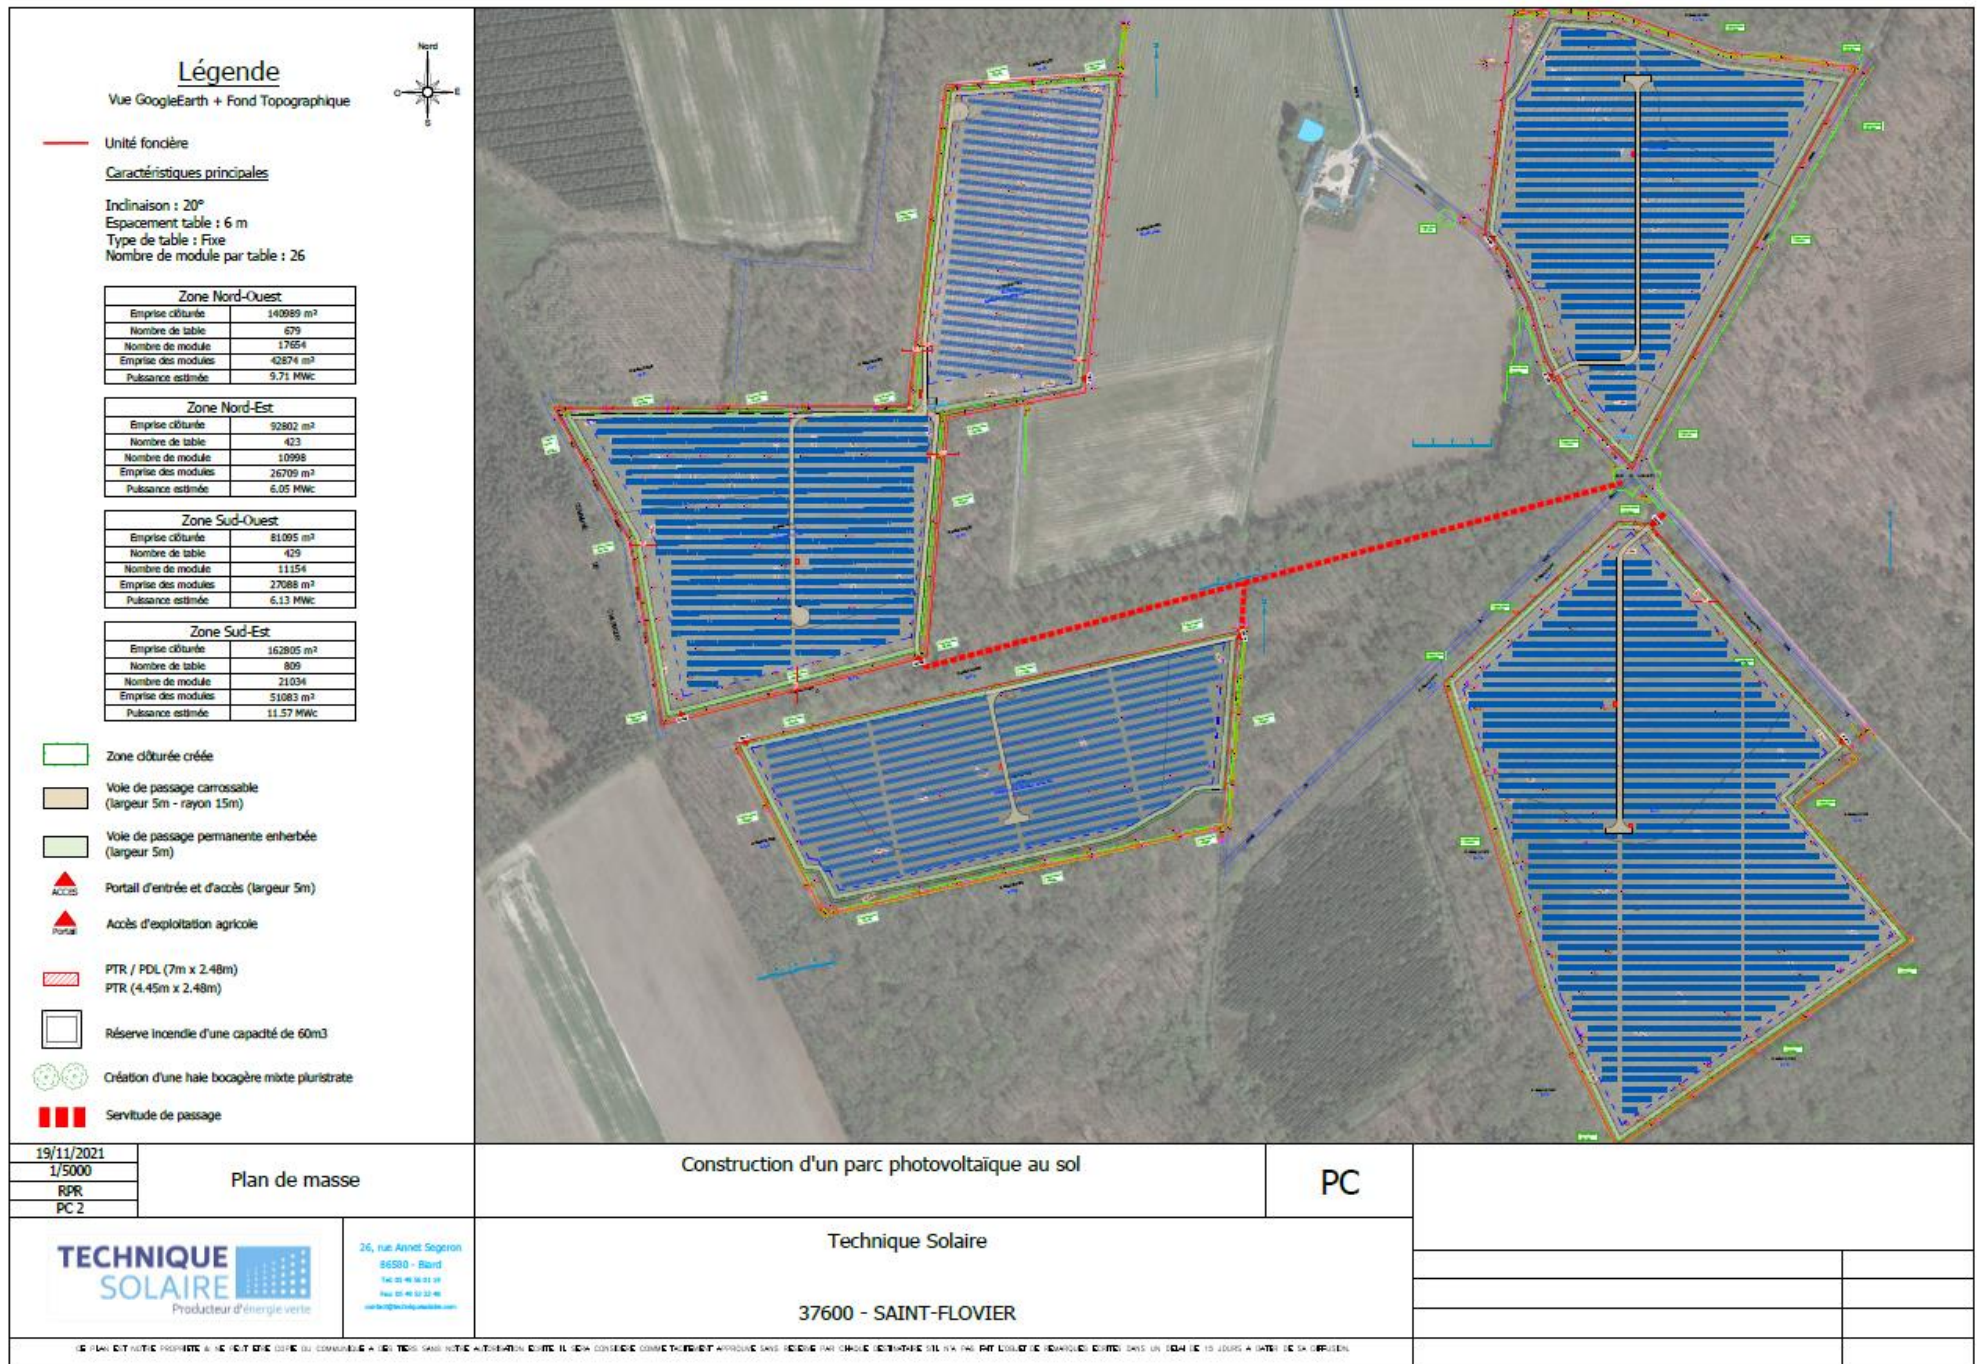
Plan de masse prévisionnel de la centrale photovoltaïque (Technique Solaire, 2021)
